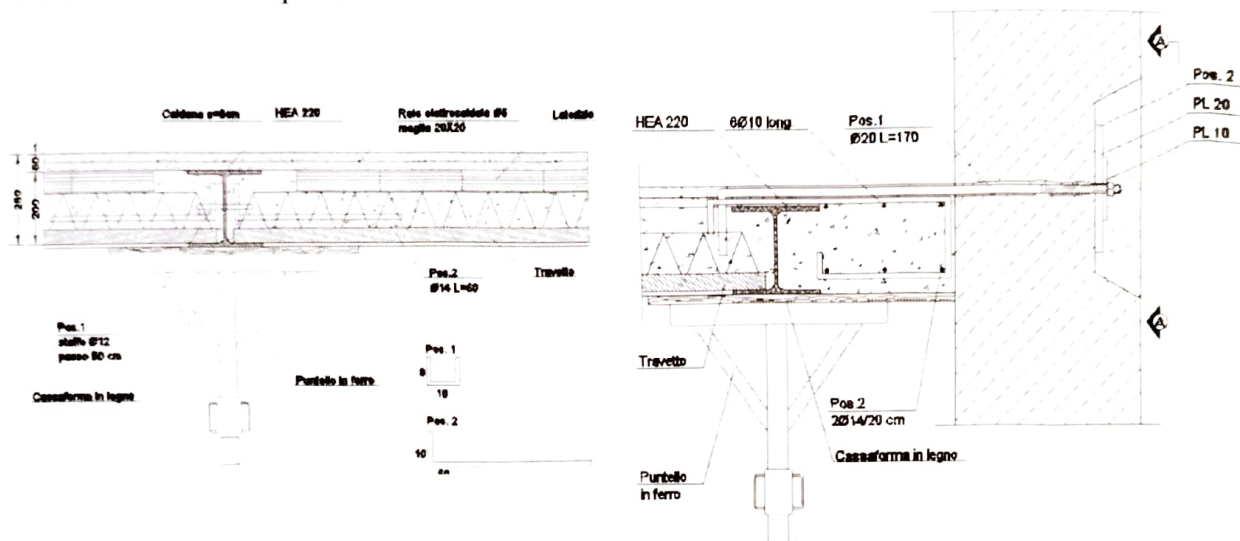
Particolari: A) collegamento travetti – trave in acciaio, B) Ammorsamento solaio-muratura
